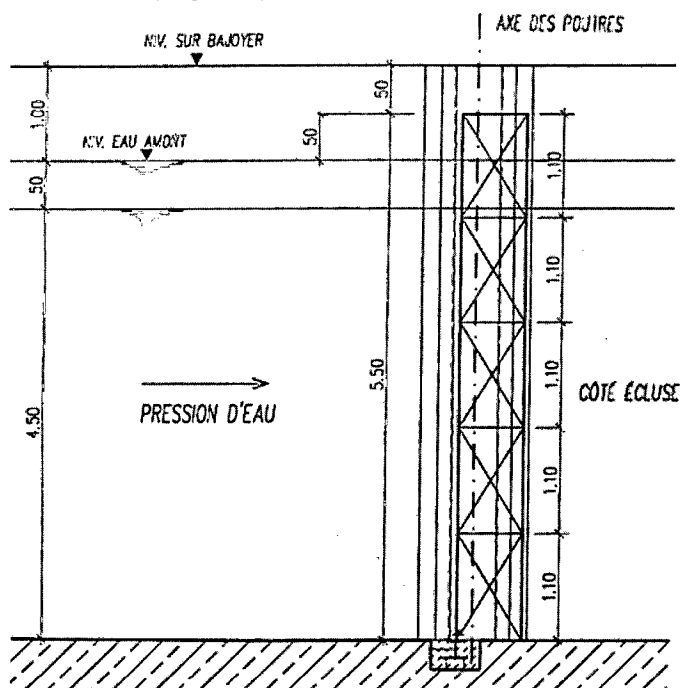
Barrage à poutrelles (coupe transversale)
